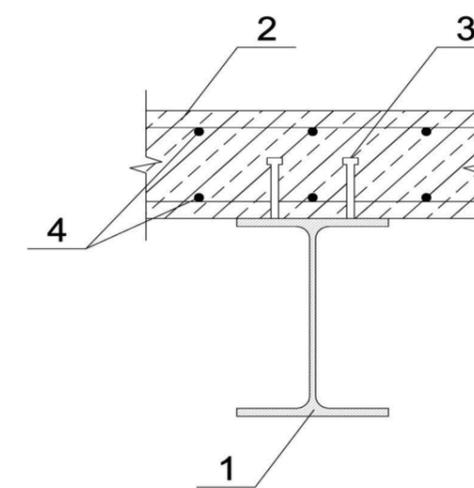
Стальная балка и монолитное перекрытие объединены в комбинированную систему при помощи анкерных упоров. 1- балка; 2- бетон; 3- анкерные упоры; 4- арматура
